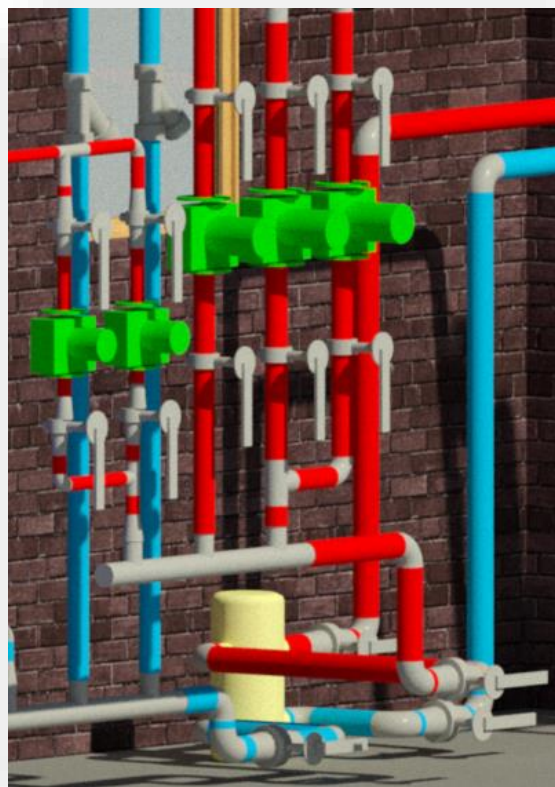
Detalle bombas y colectores bloque de viviendas en Avenida Salamanca
